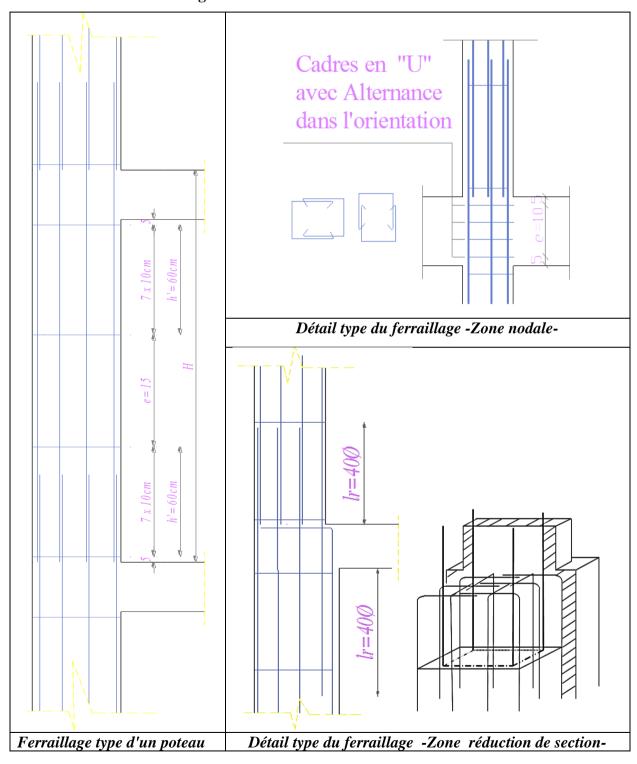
Ferraillage des poteaux (Coupe verticale)
